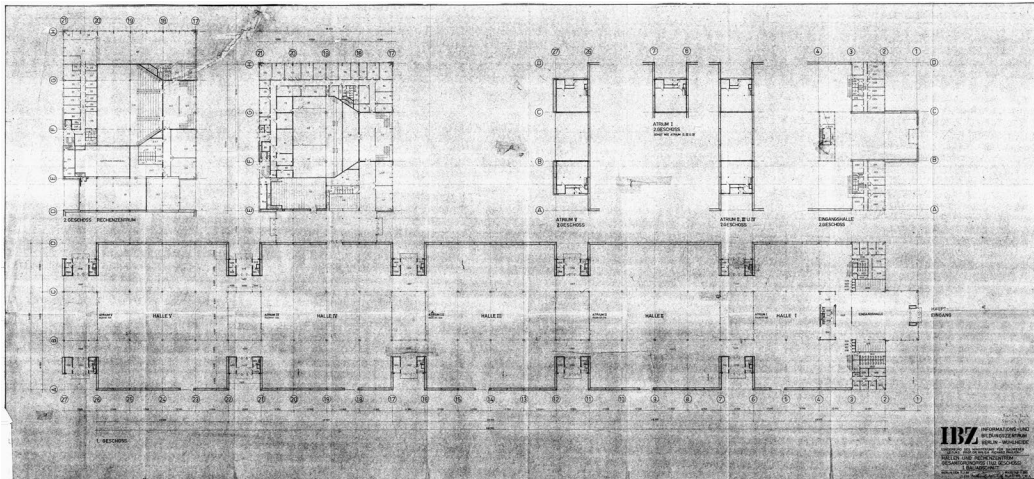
Richard Paulick, Sonderbüro des Ministeriums für Bauwesen, Informations- und Bildungszentrum Berlin-Wuhlheide, Hallen und Rechenzentrum, Gesamtgrundriss (1. und 2. Geschoss), I. Bauabschnitt, Berlin, 11.02.69, überarbeitet 21.02.69, Maßstab 1:200, Blatt-Nr. 1.10A.
